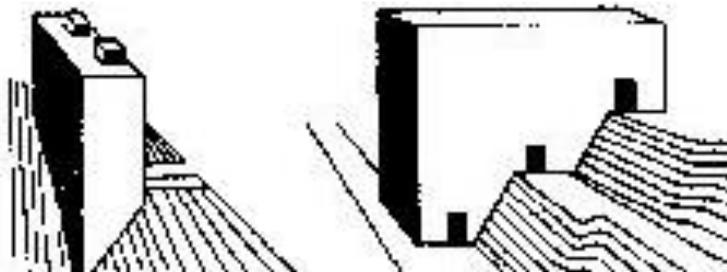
Расположение многоэтажного жилого здания вдоль и поперек склона [5]
